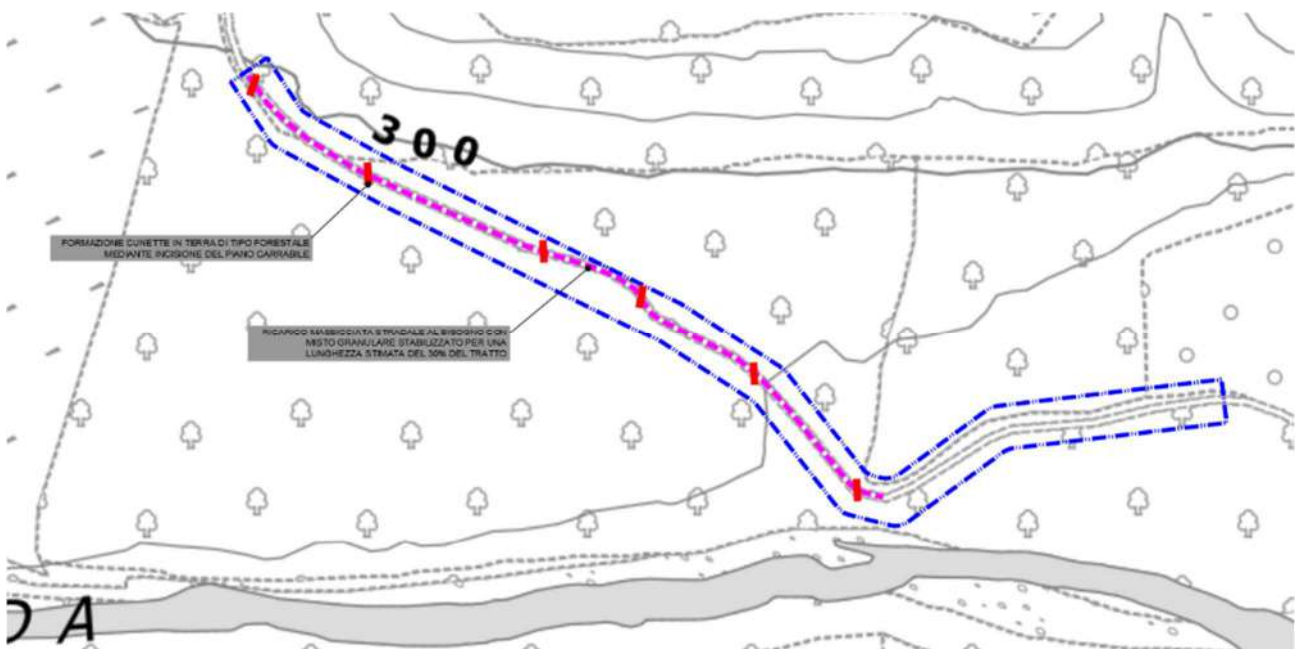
Planimetria di progetto. (rappresentazione non in scala)
